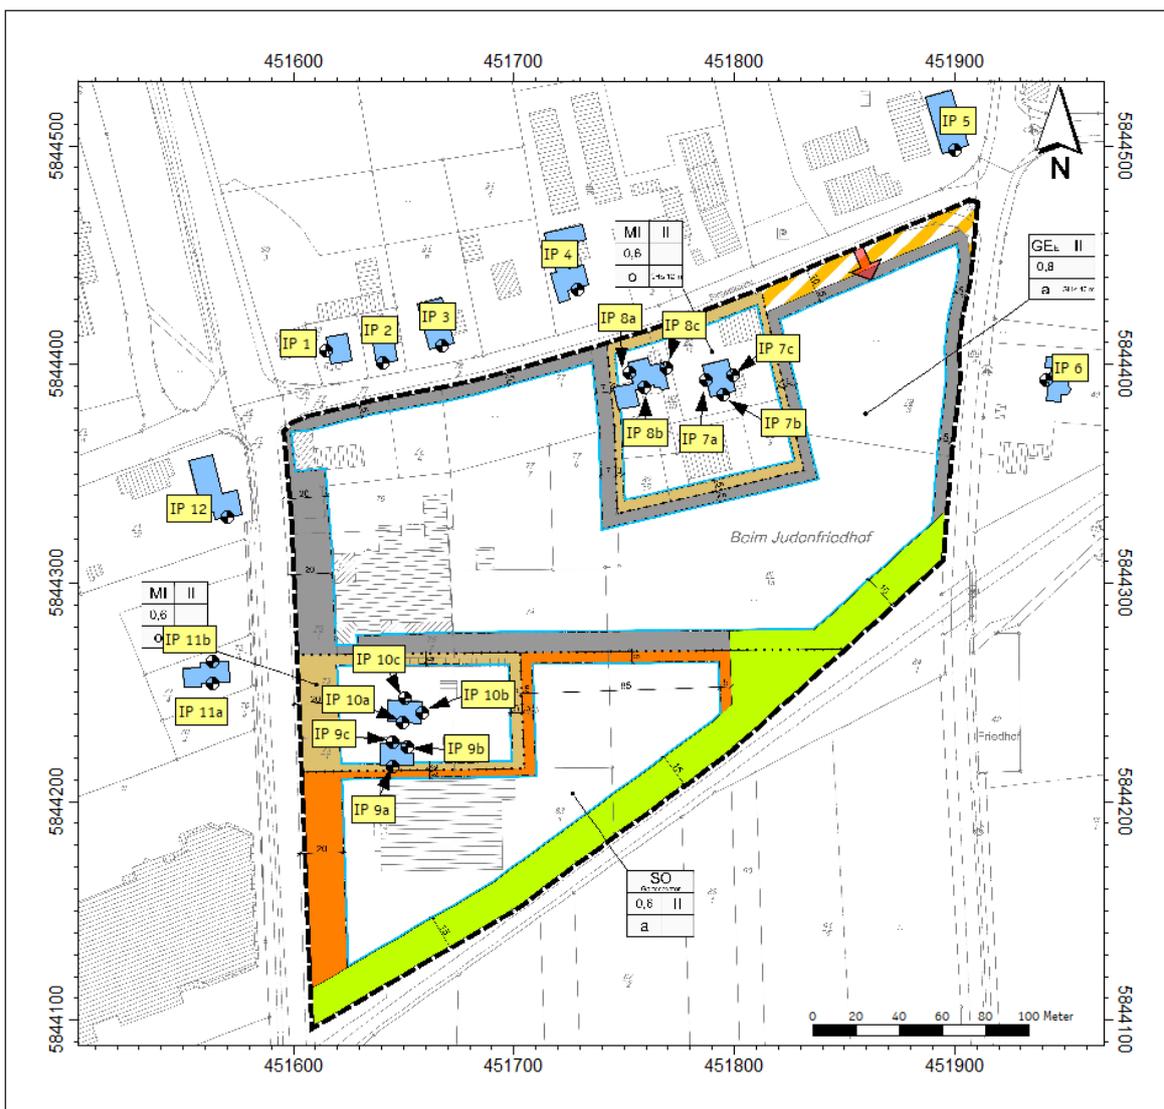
Lage der maßgeblichen Immissionsorte (Quelle hinterlegter Plan: [15]).
